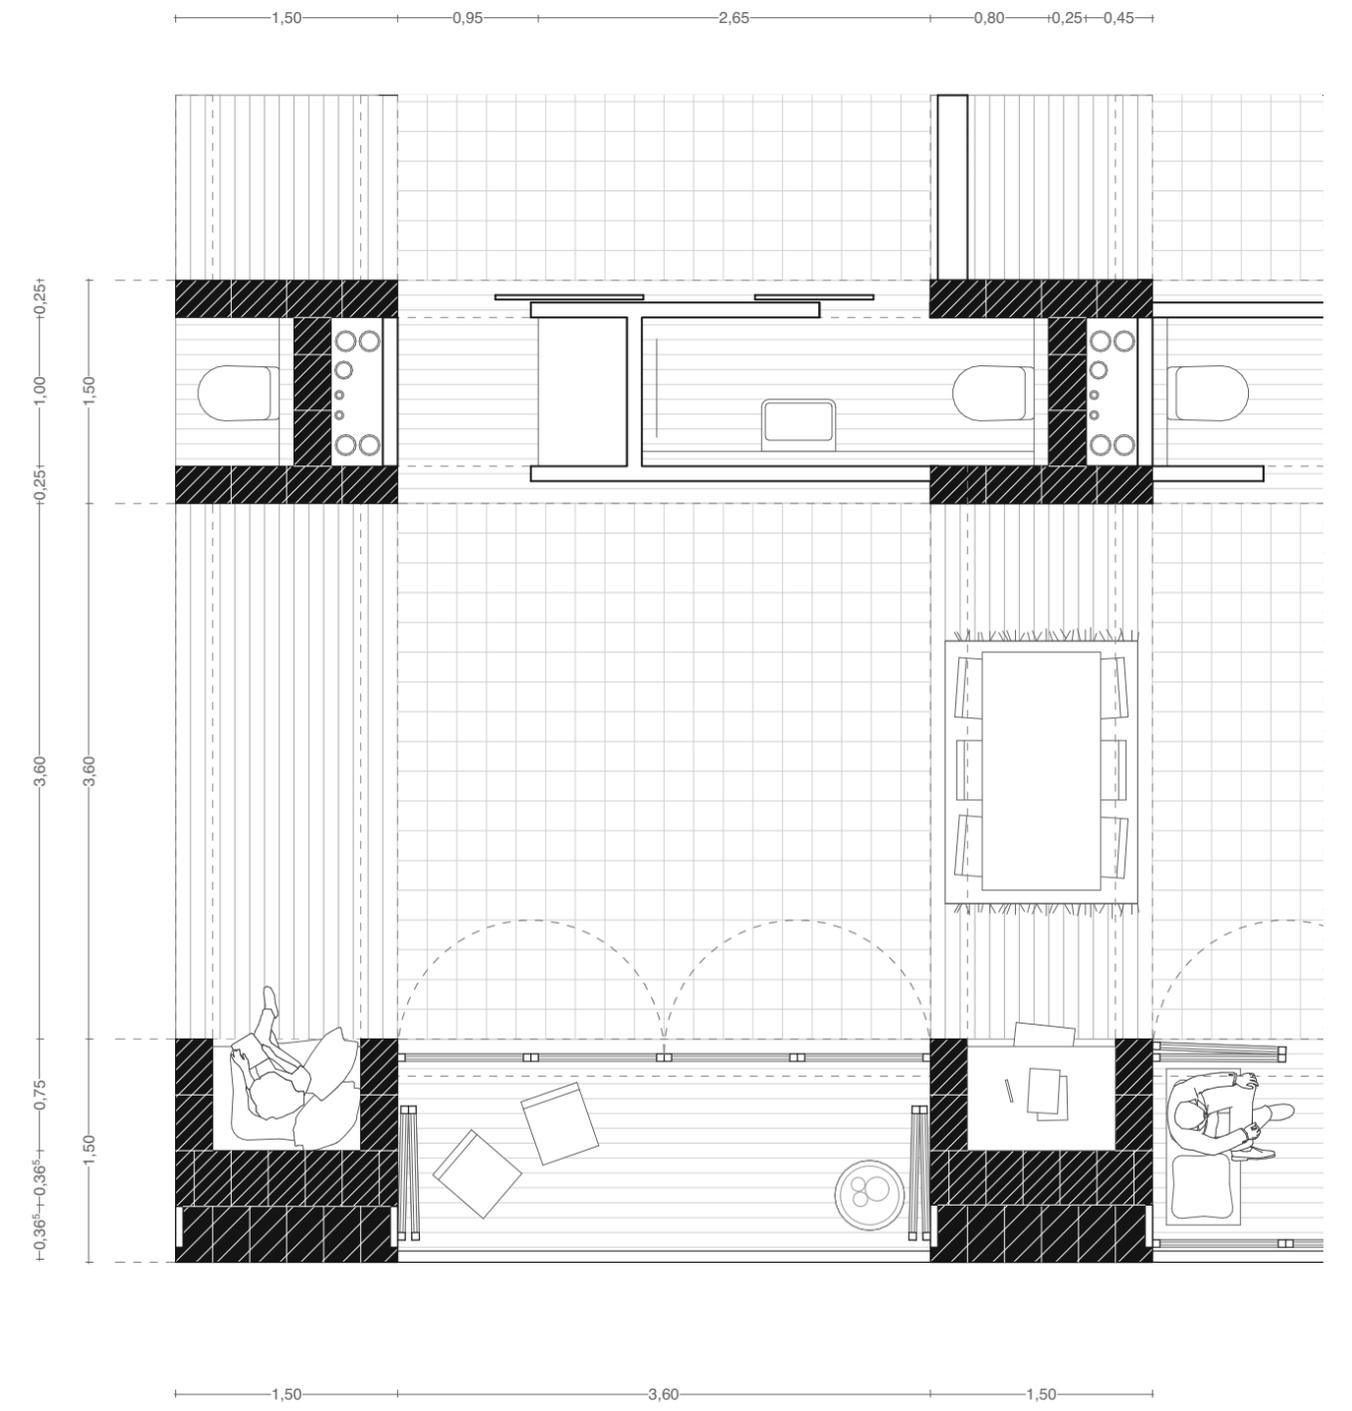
Wanddetail Projekt „2226“ – Baumschlagler Eberle mit zweischaliger Ziegelkonstruktion
